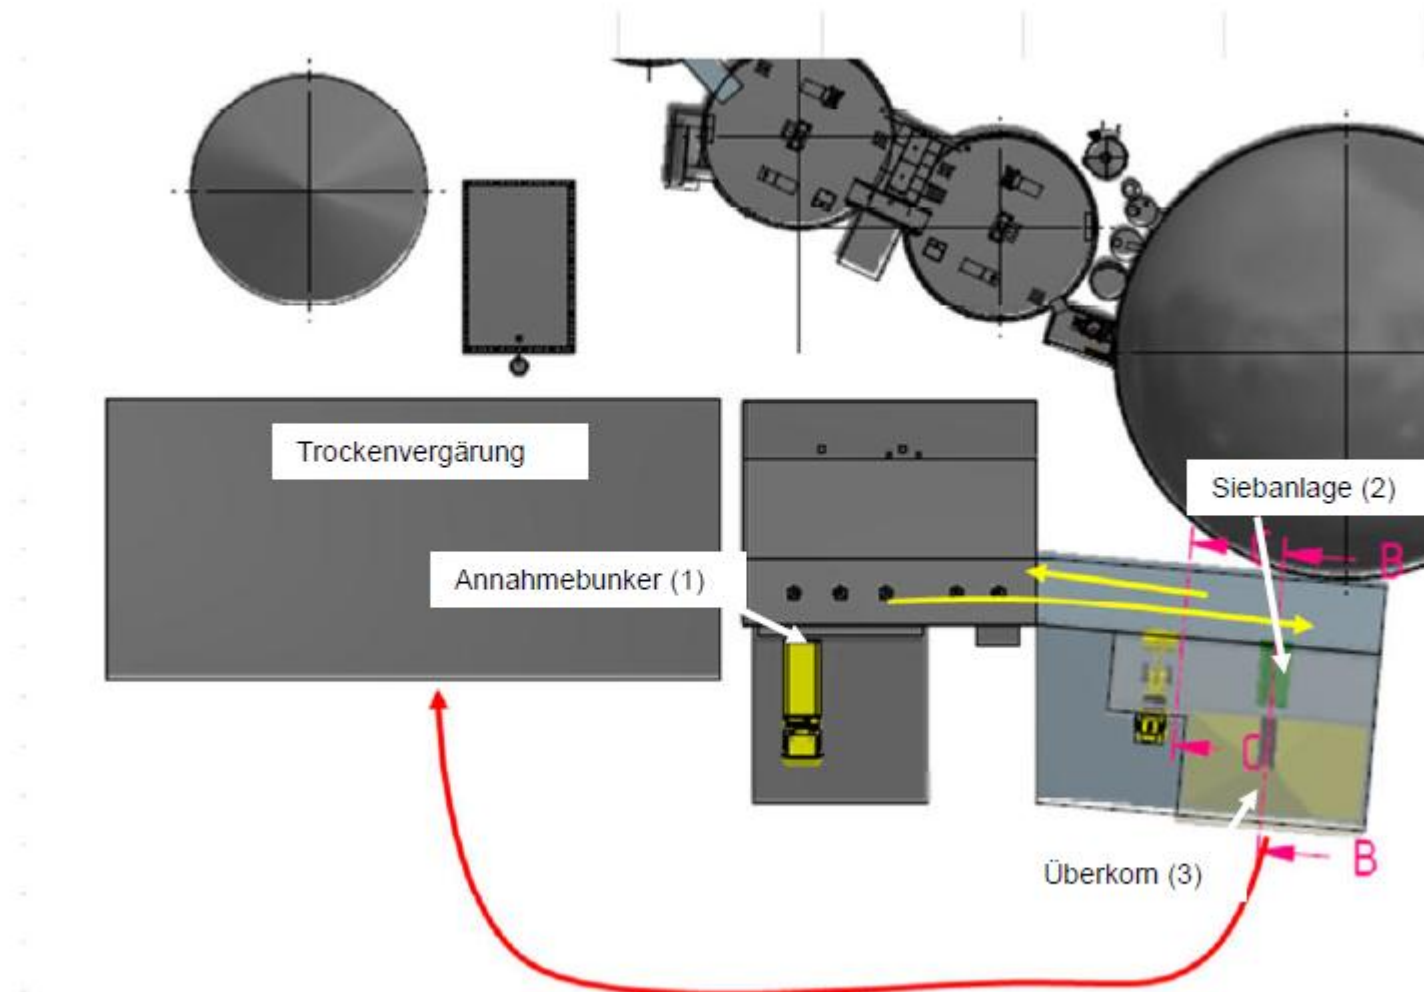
Layout 16: Anordnung der stationären Siebung in einem Anbau zur Aufbereitungshalle
